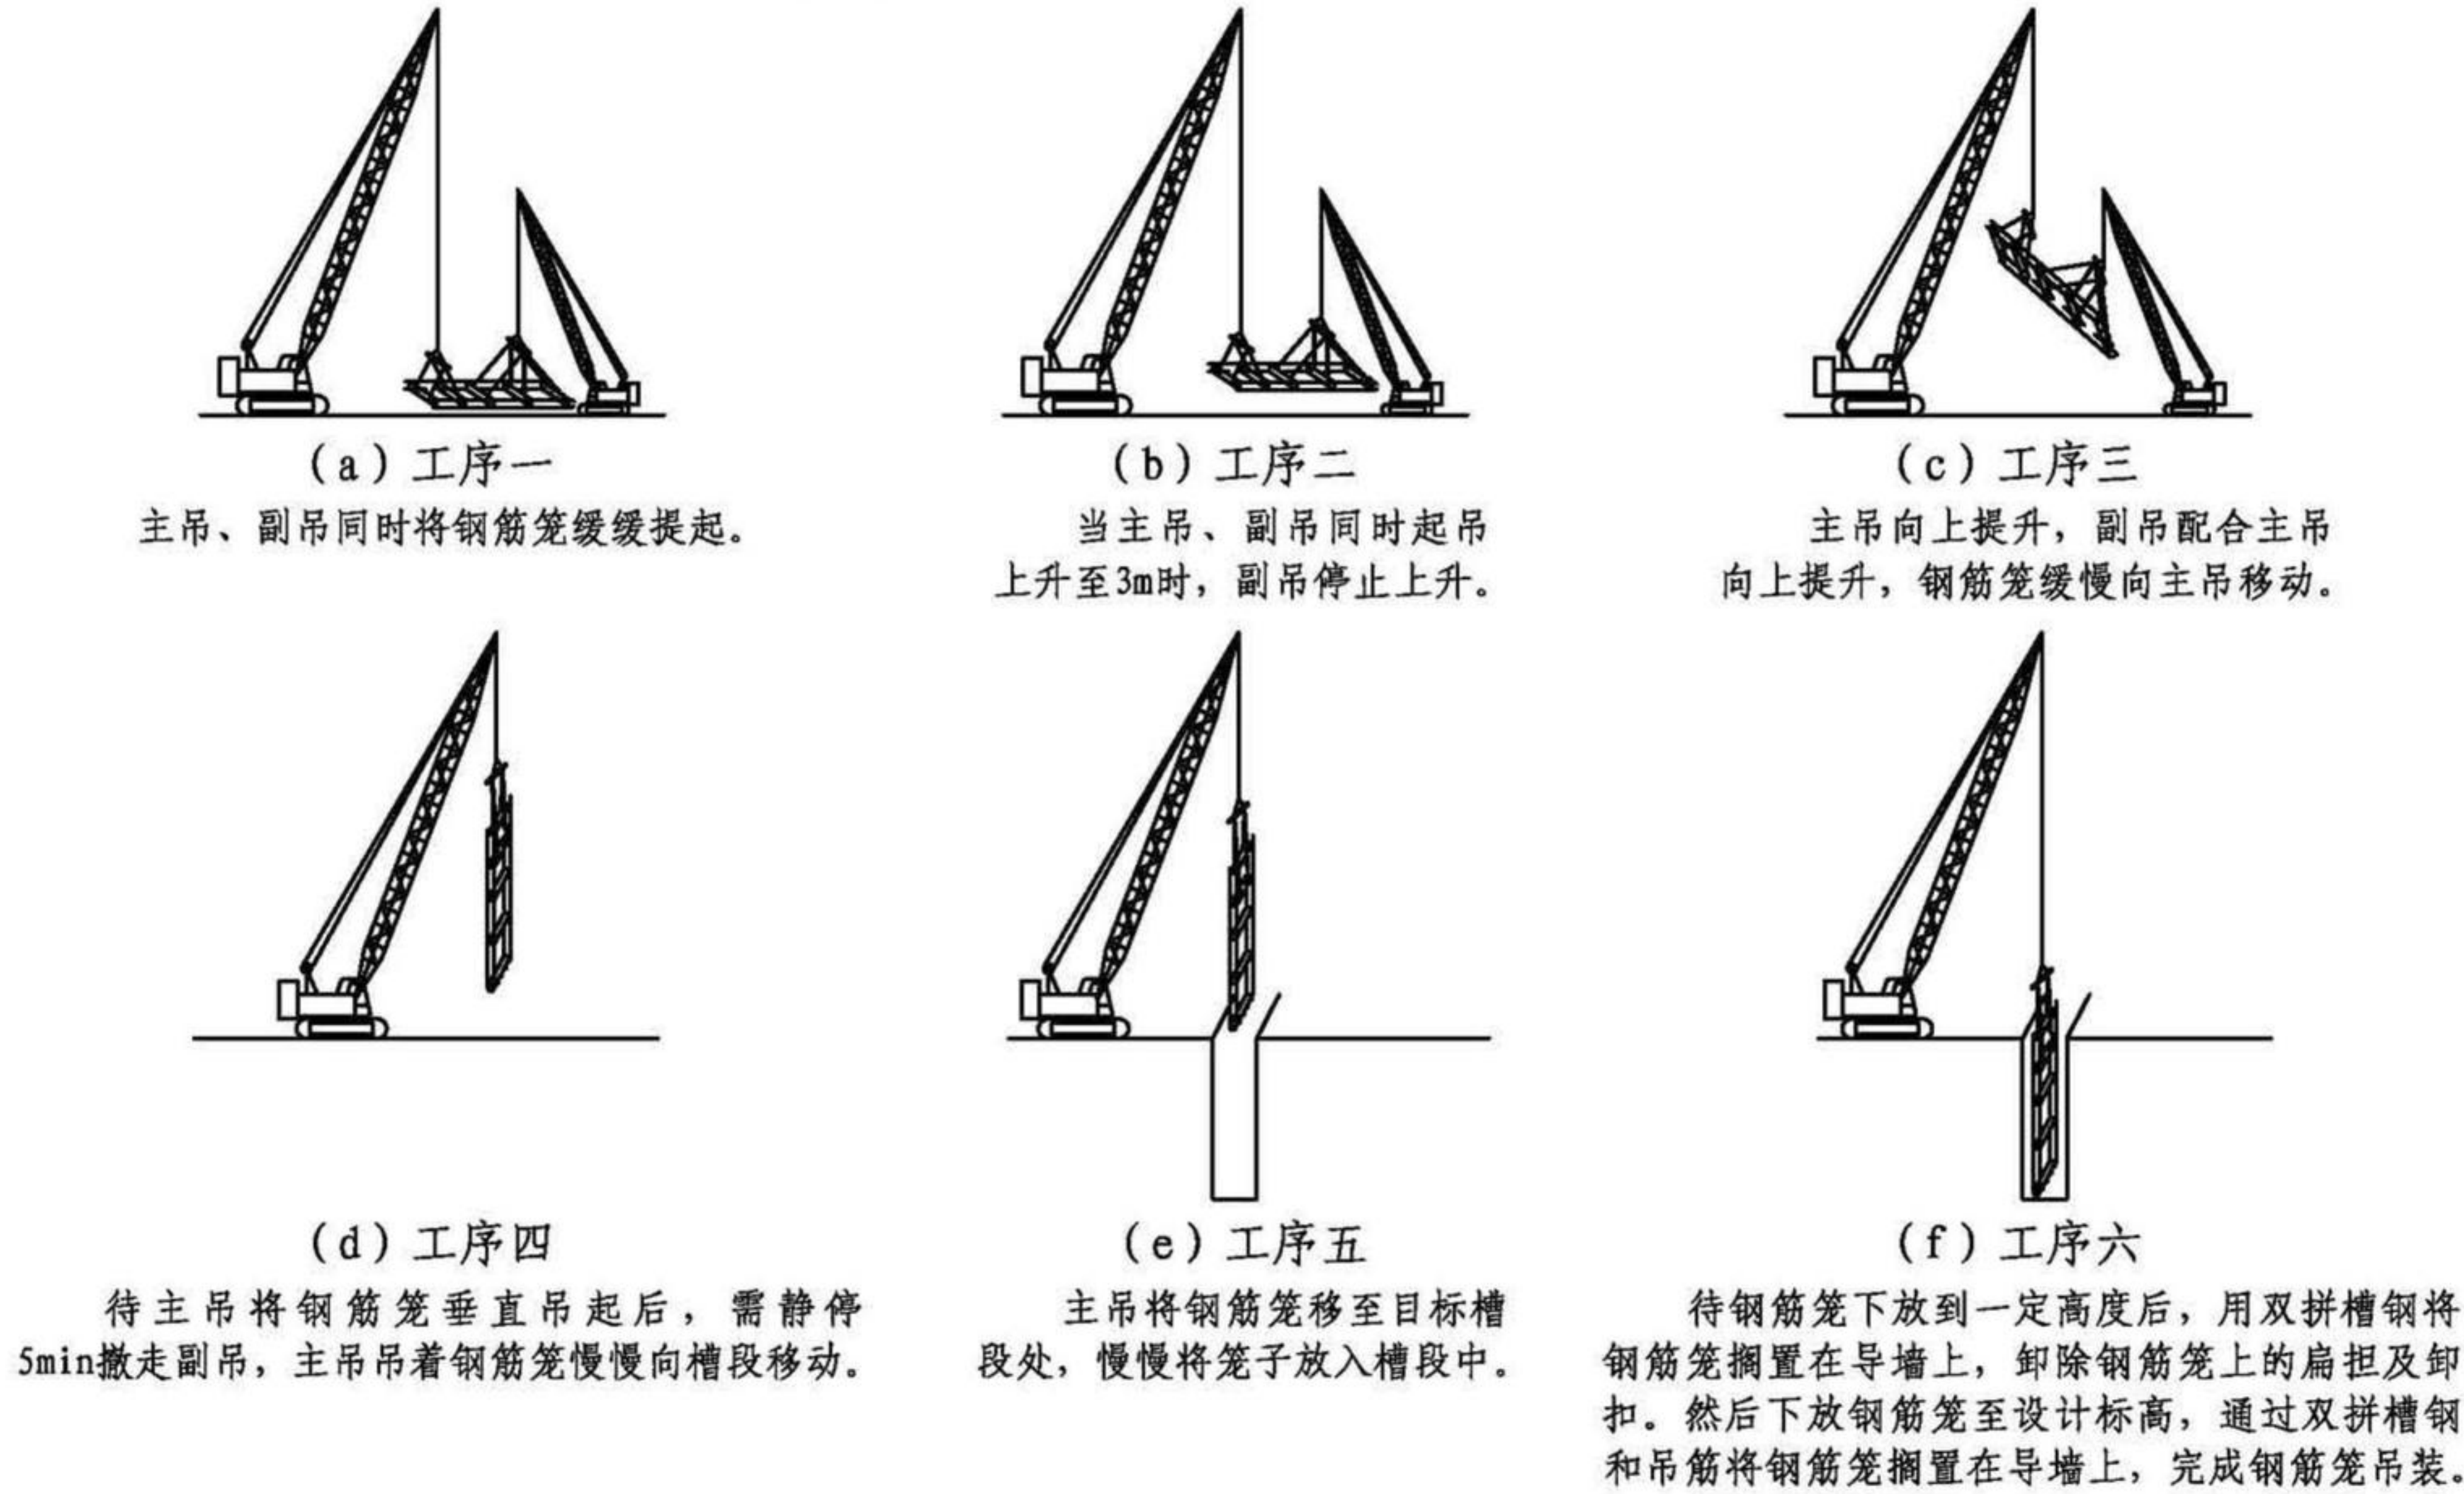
地下连续墙钢筋笼吊装施工工序示意图
